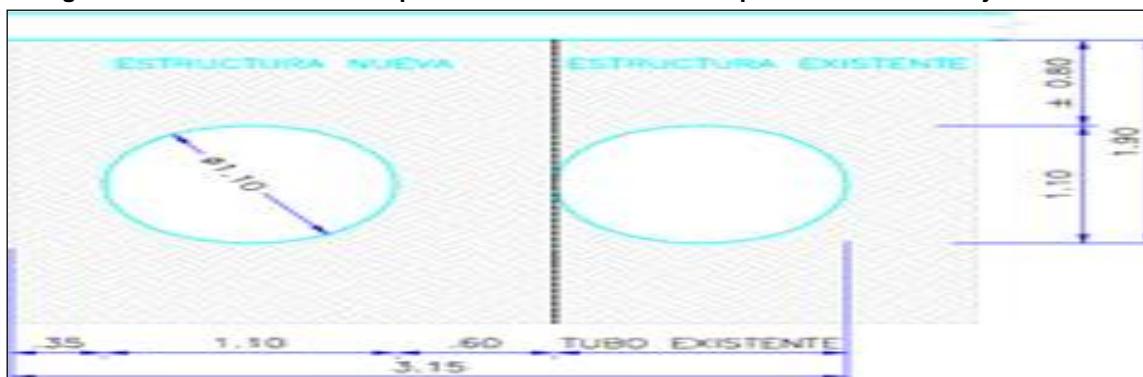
Planos de diseño de planta Box Culvert nueva estructura de drenaje PR84+040
